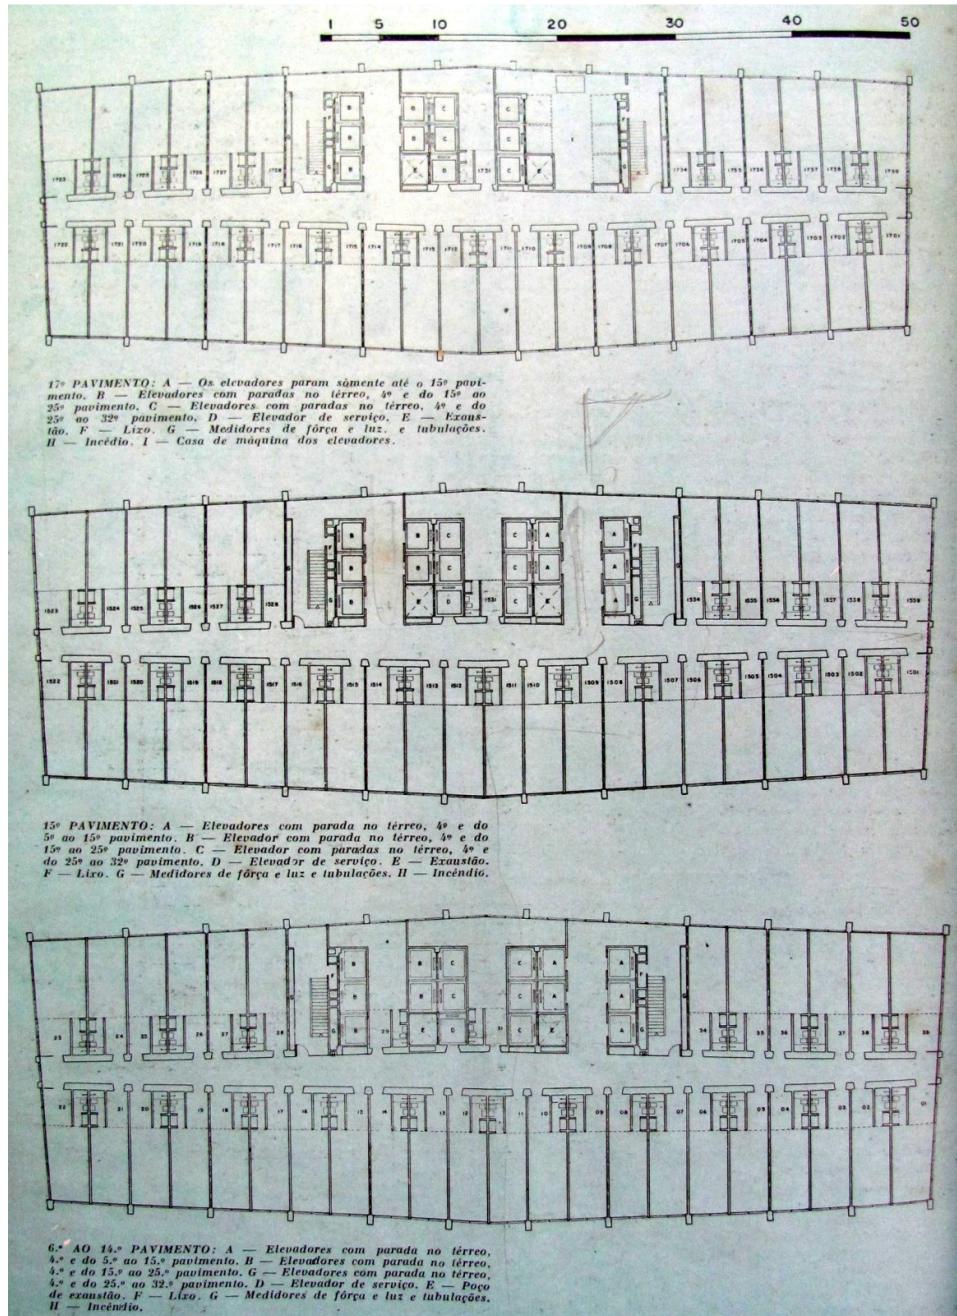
G – Variações de plantas baixas dos pavimentos tipo da torre
